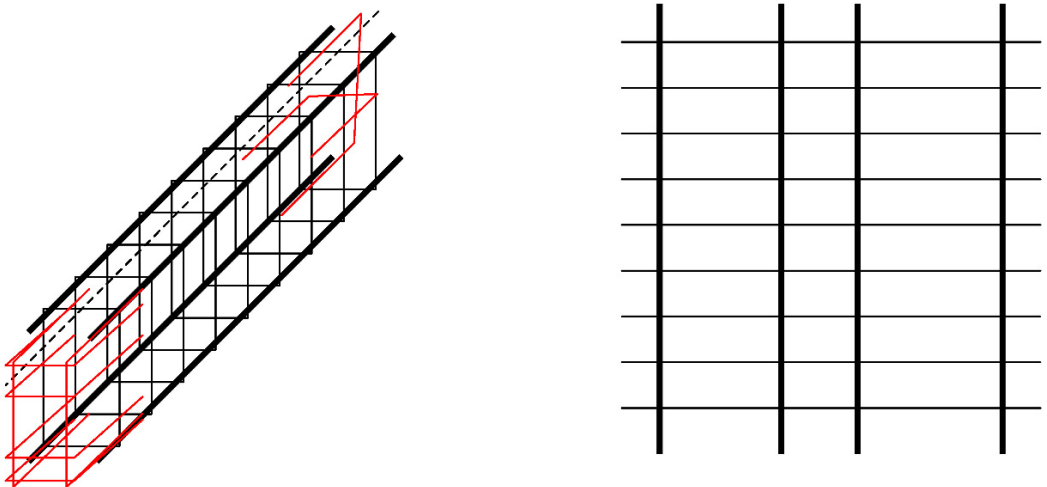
Ein Unterzuggeflecht, welches oben längs geschnitten die ebene Stahlmatte ergibt (ohne „Abrissbügel“).
